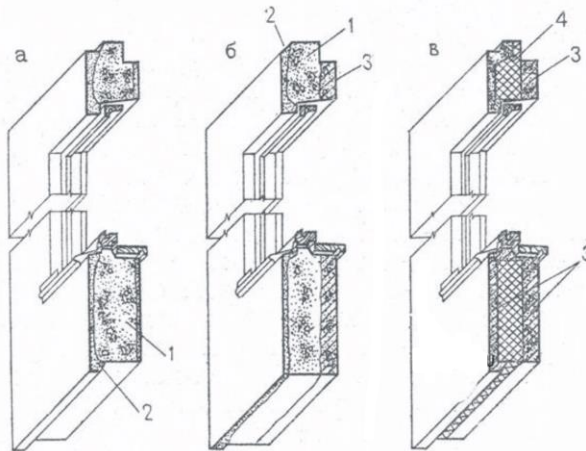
Бетонные панели наружных стен: а – однослойная; б – двухслойная; в – трехслойная; 1 – конструктивно-теплоизоляционный бетон (керамзитобетон плотностью от 1400 кг/м^3); 2 – защитно-отделочный слой; 3 – конструктивный бетон; 4 – эффективный утеплитель
